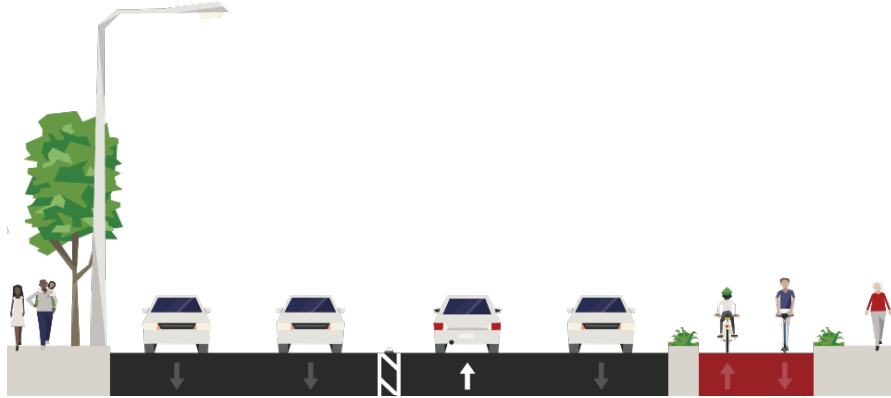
Sección transversal con acera bici protegida con borde vegetal. Fuente: Elaboración propia Streetmix.
